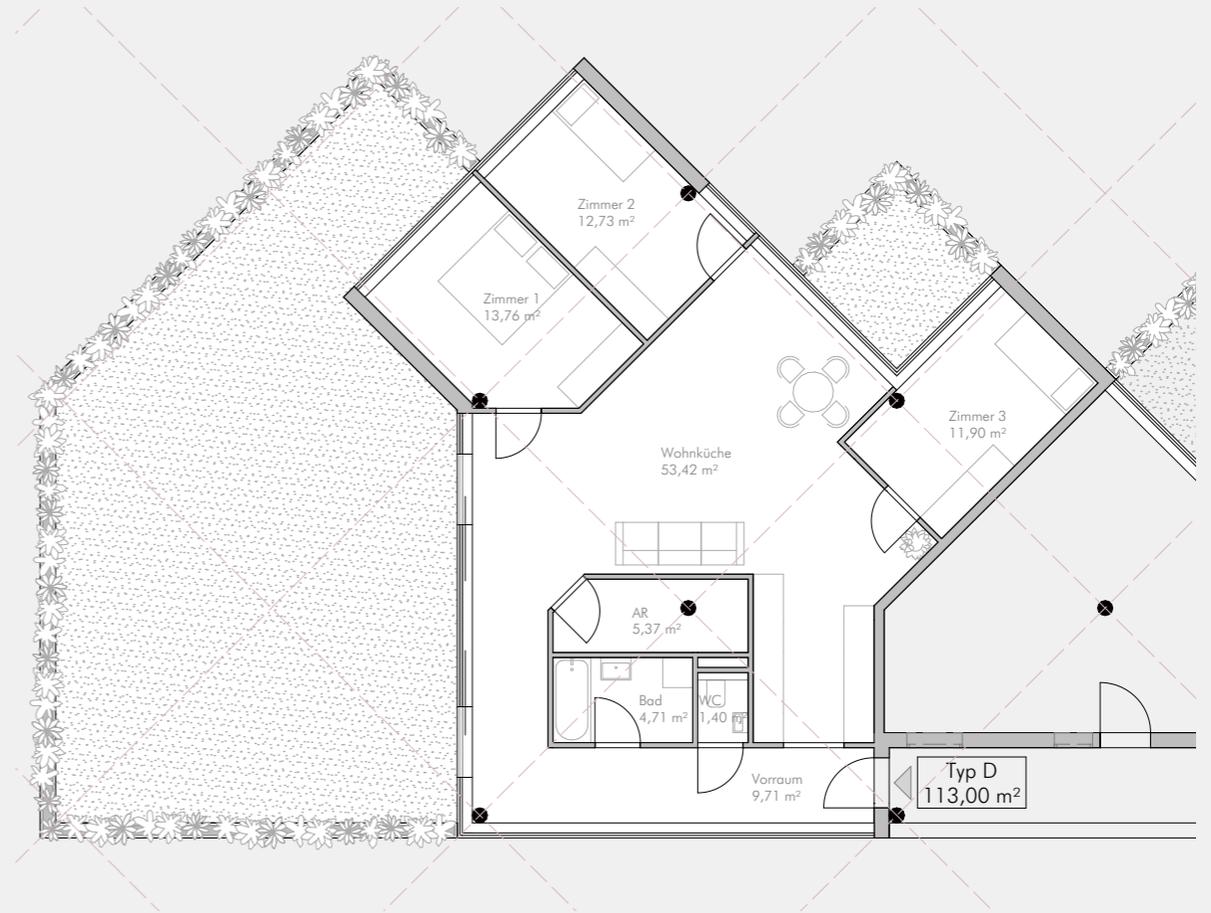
| Grundriss einer Dachgartenwohnung des Typs D im Maßstab 1:150
